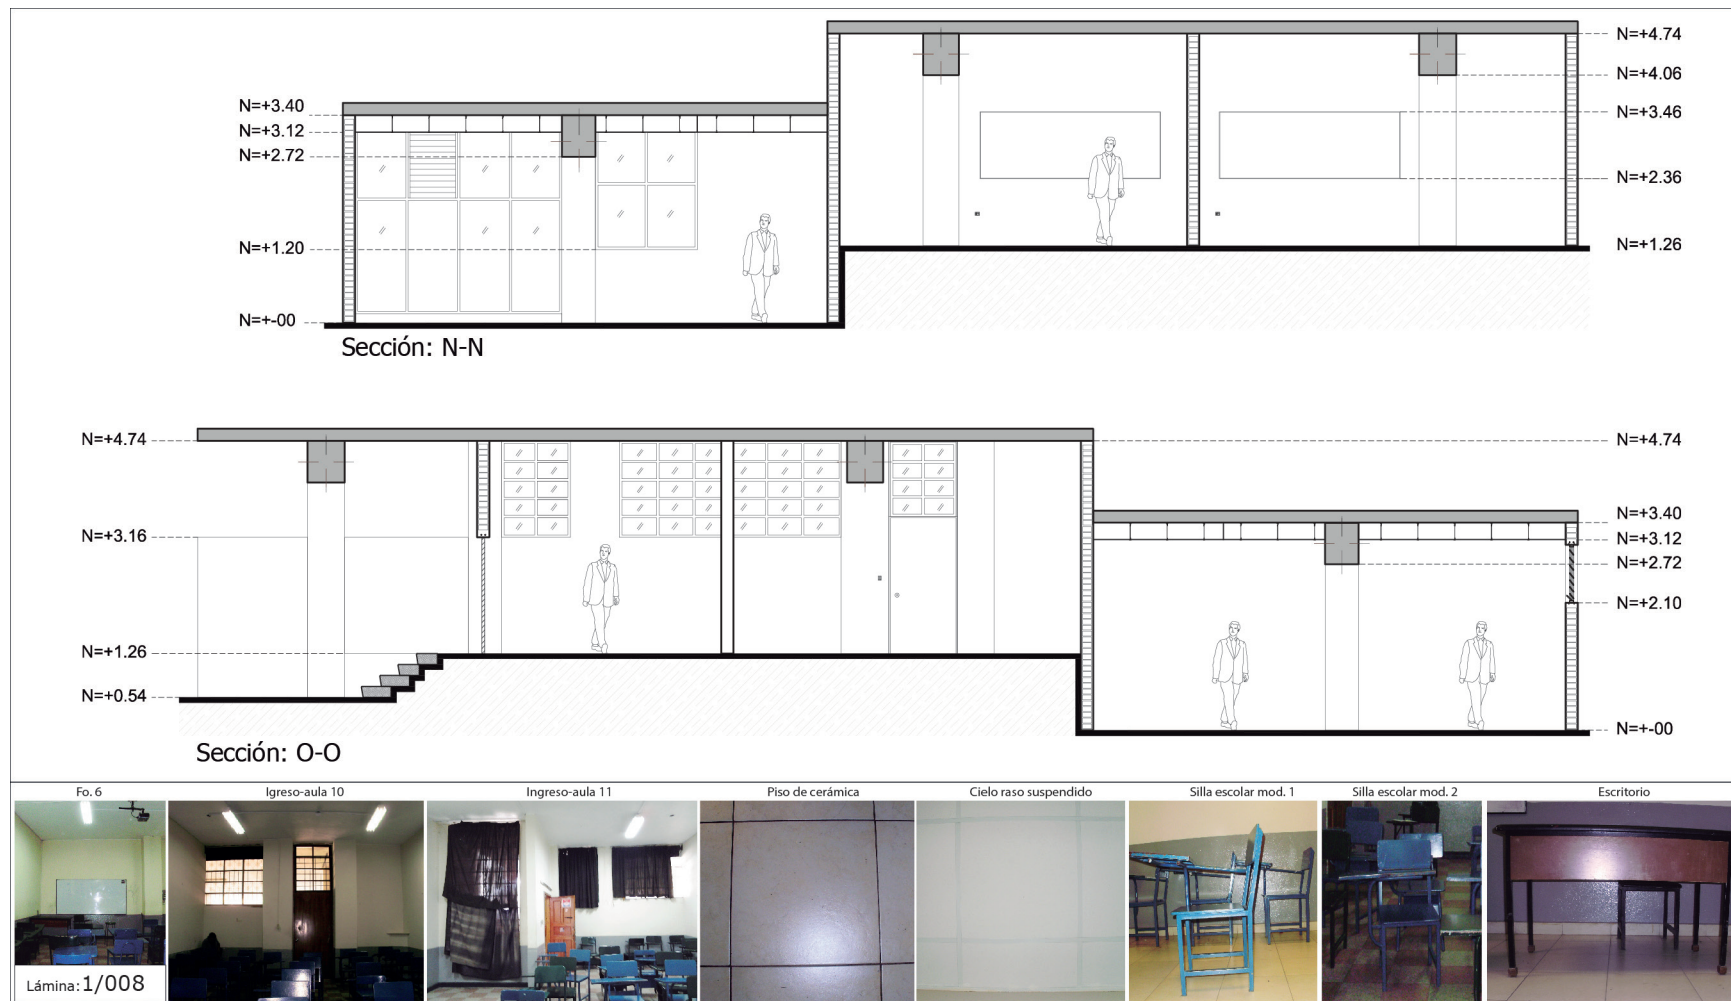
Secciones de las aulas: 8-9-10-11 estado actual.
